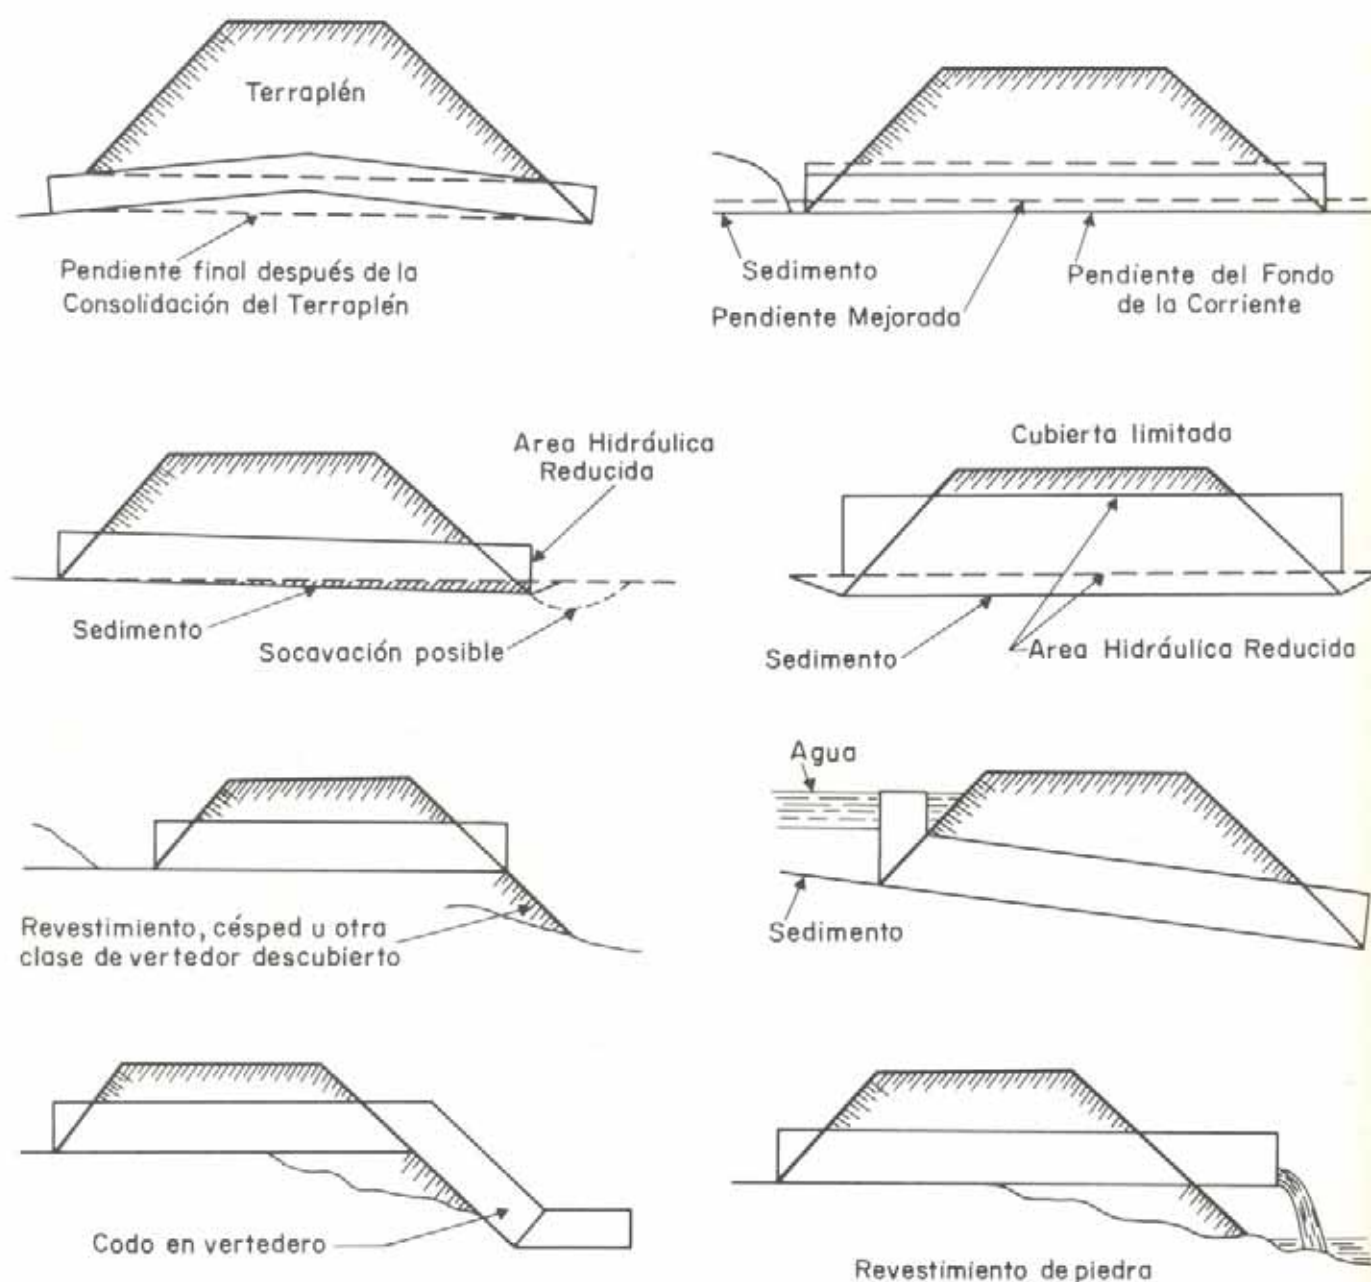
Variaciones en la colocación de alcantarillas bajo un terraplén.
